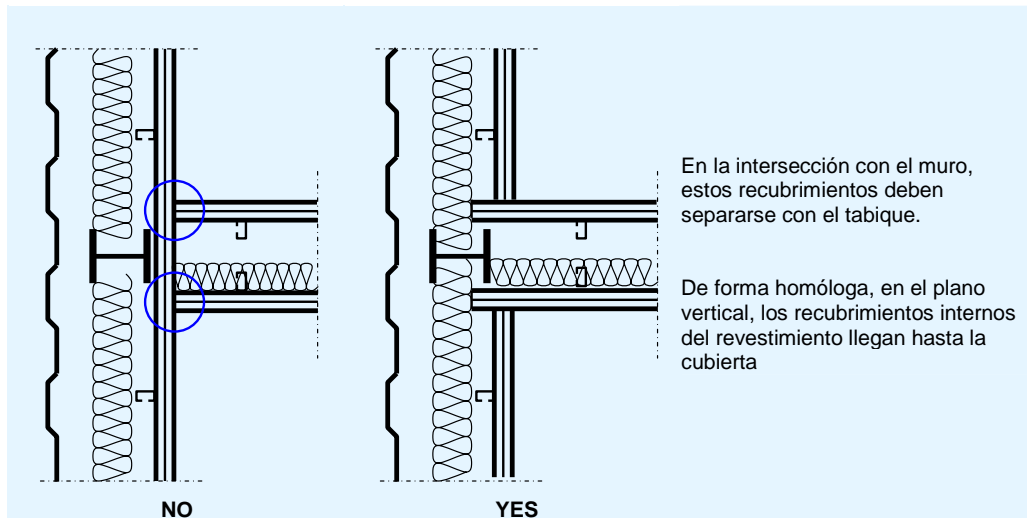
Sección transversal horizontal en la unión entre fachada y partición
